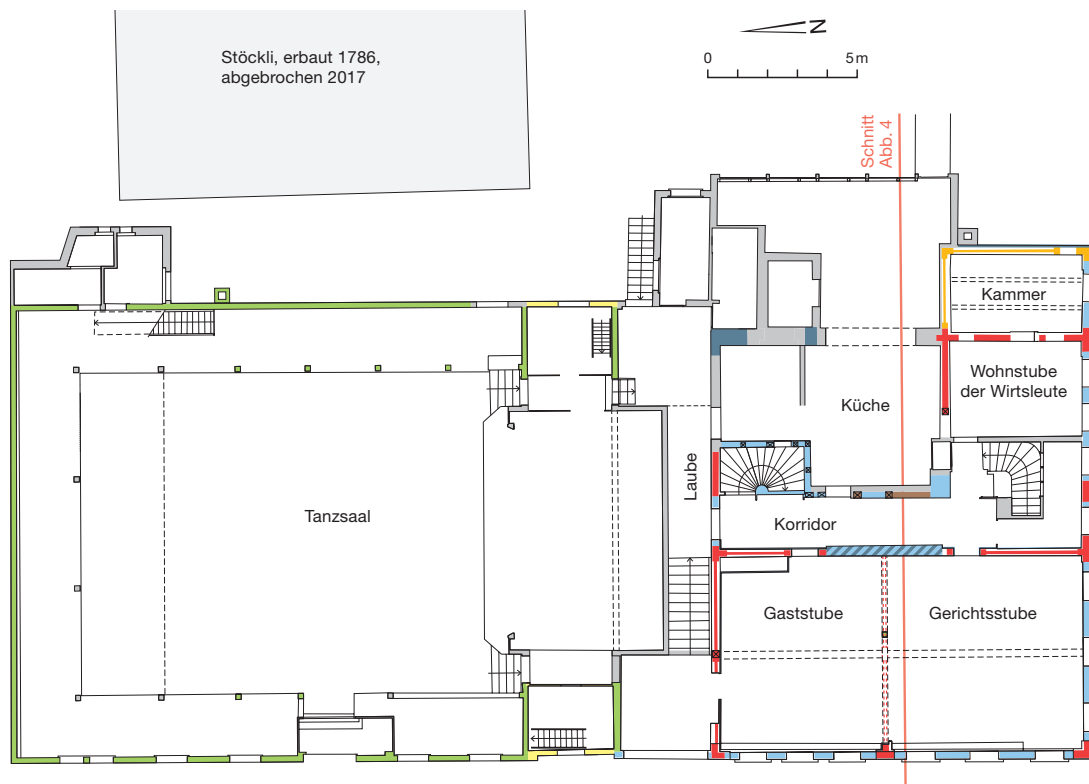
Steffisburg, Oberdorfstrasse 32. Grundrissplan zum ersten Obergeschoss mit den nachgewiesenen Bauphasen. M. 1:250.
